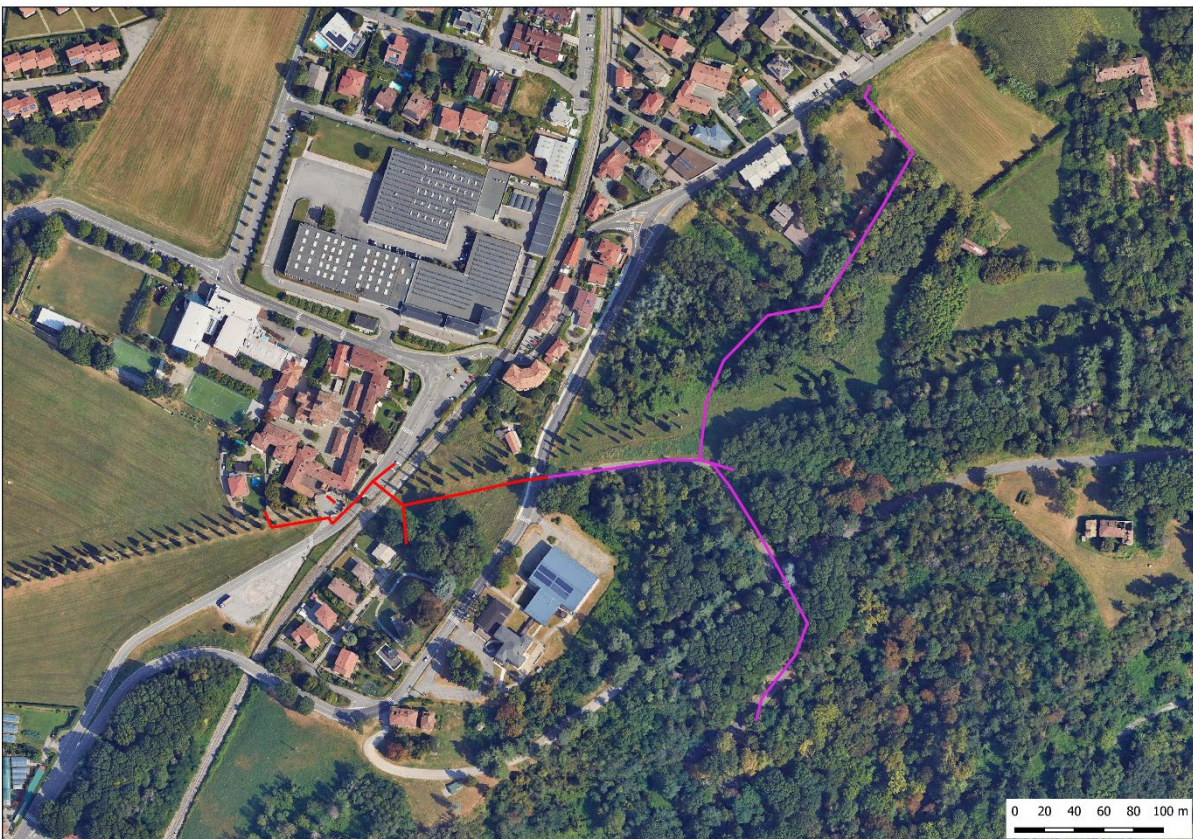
Posizionamento delle opere previste dal progetto su Ortofoto 2012 (volo AGEA).
